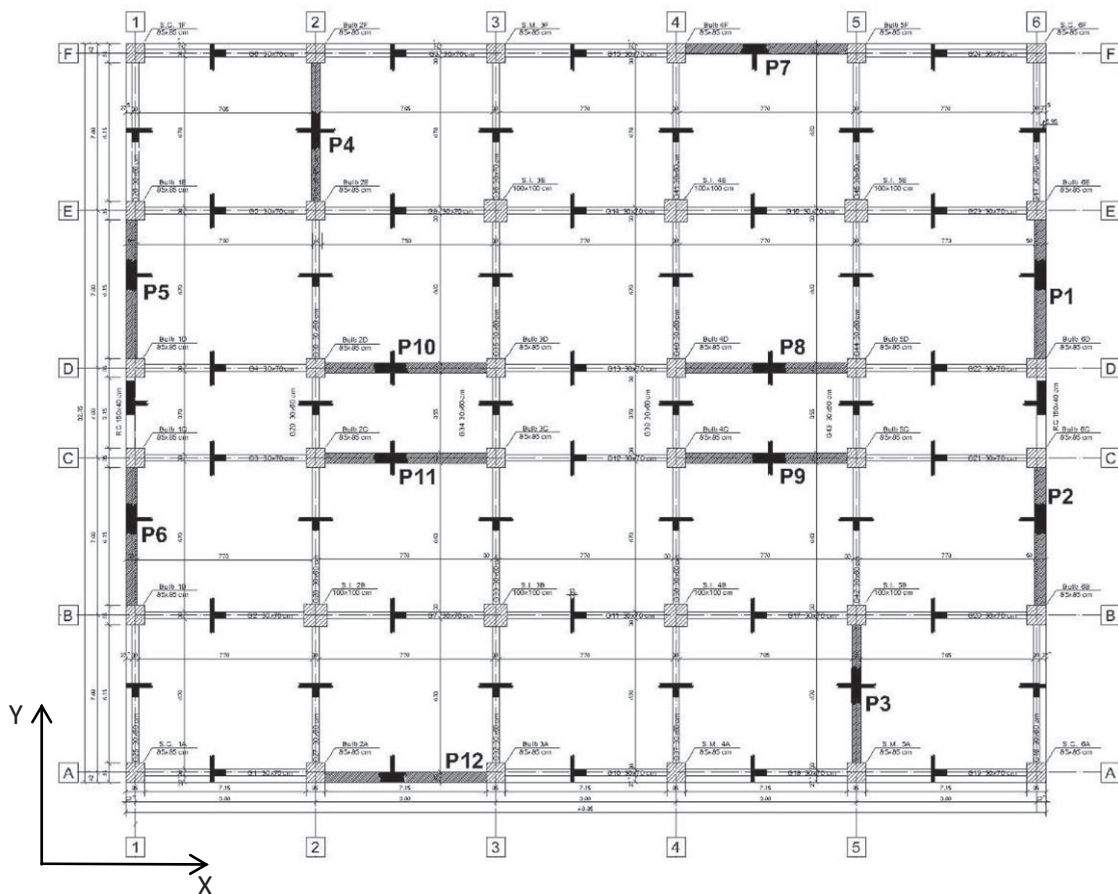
Plan cofraj planșeu etaj curent
